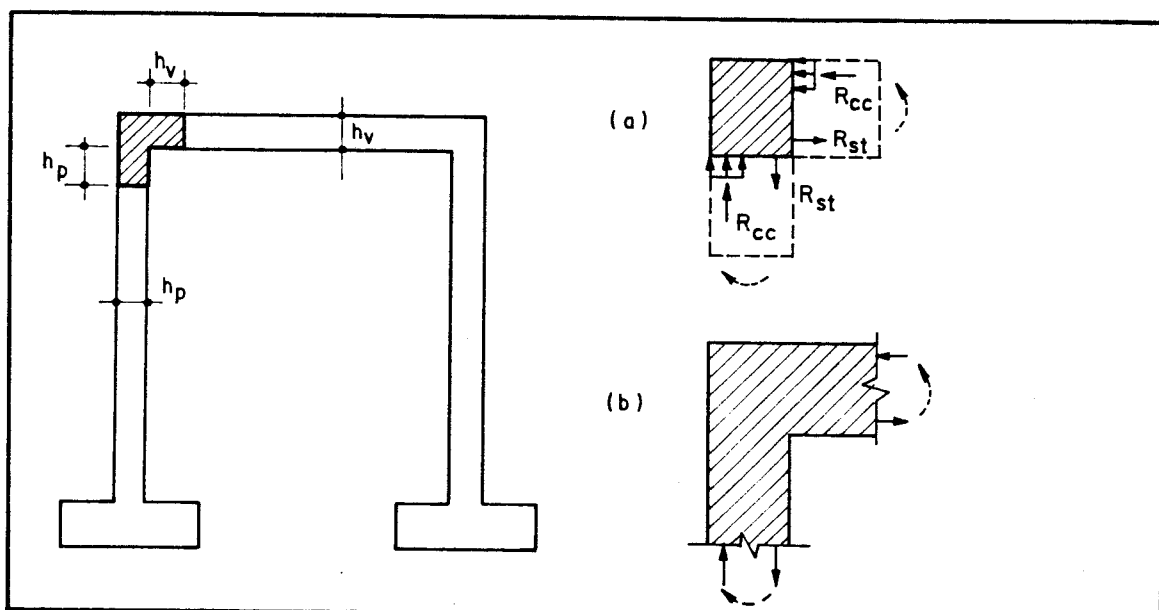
Ligação viga-pilar de um pórtico simples e seu contorno.
